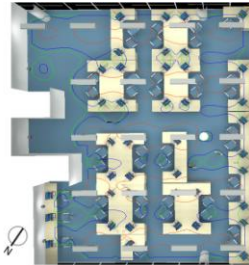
Planta Baixa com as isolinhas da solução adotada para as áreas de escritório com planta livre.
